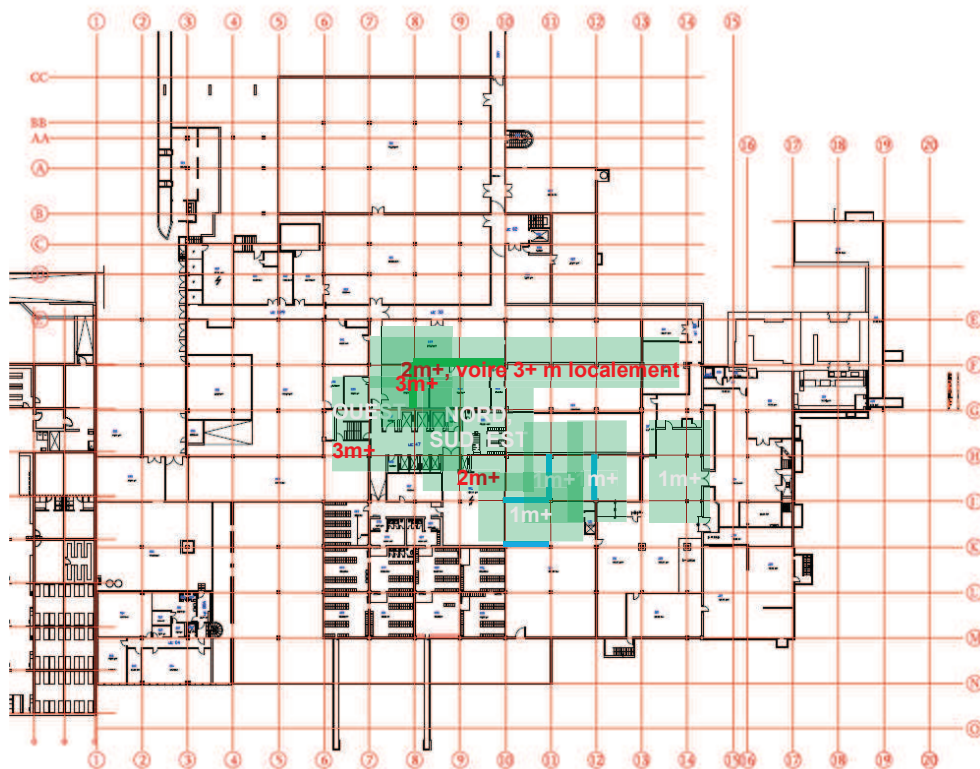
Plan du sous-sol, niveau U. Fondations superficielles indicatives.
